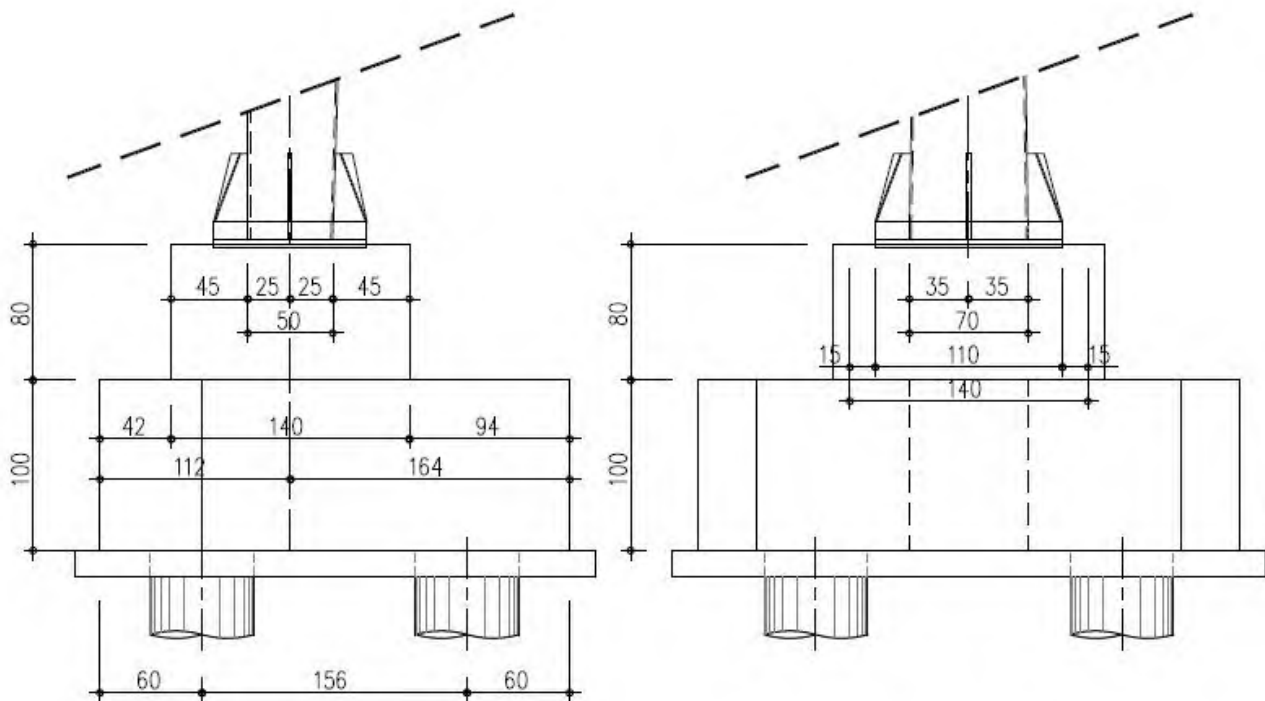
Sezioni del plinto di fondazione - terreno pianeggiante
